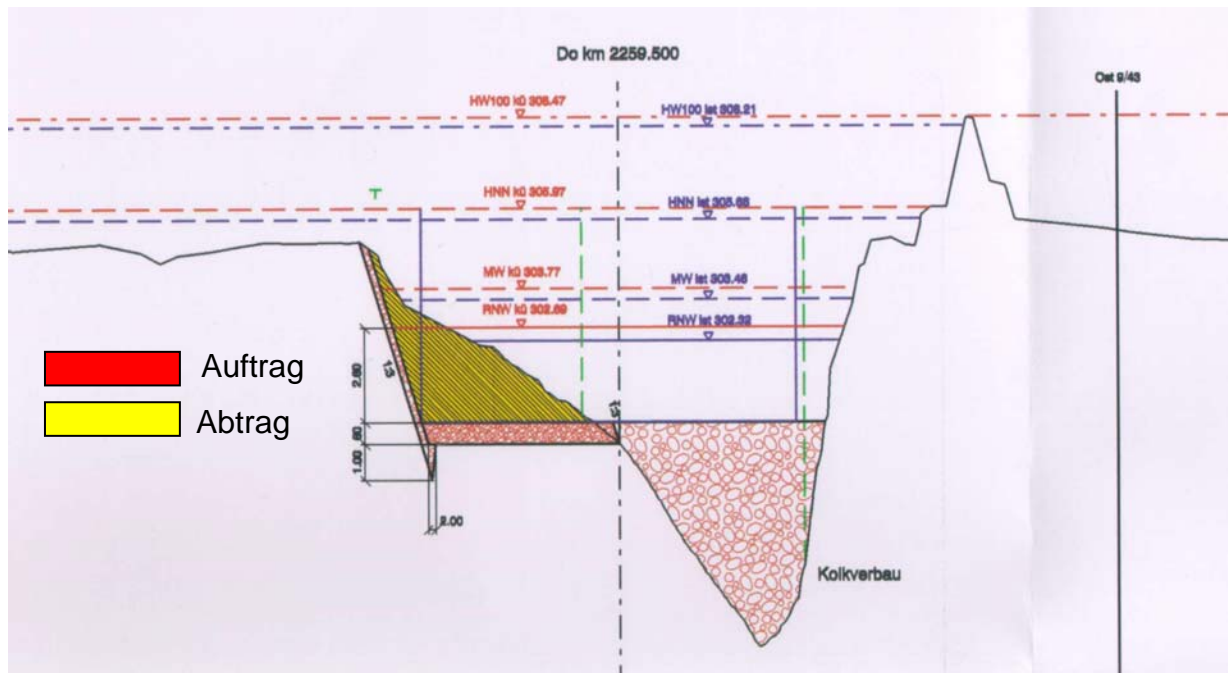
Querschnitt bei Variante B mit Deckwerk (Planunterlagen RMD)
